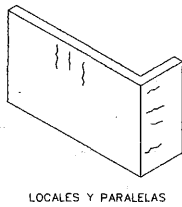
Tipología de grietas en elementos estructurales.
